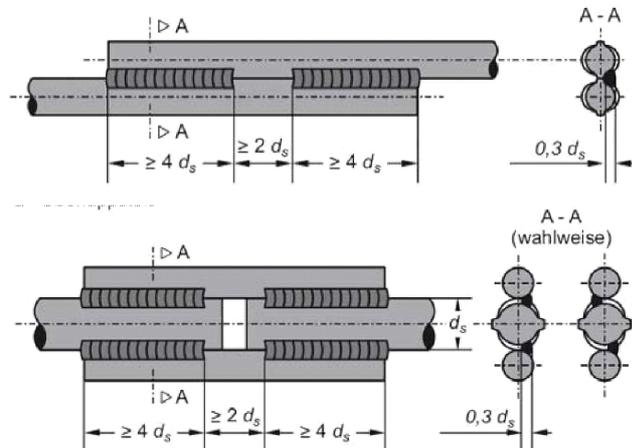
direkte Stoßverbindungen (KOLLEGGGER, Betonbau 1, 2007)
